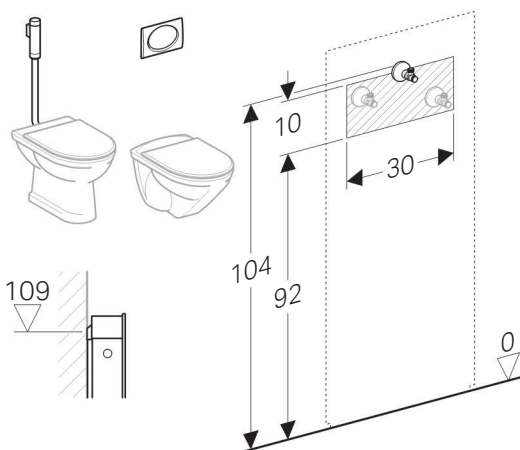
Massbereich Wasseranschluss verdeckt, Bauhöhe 114 cm
